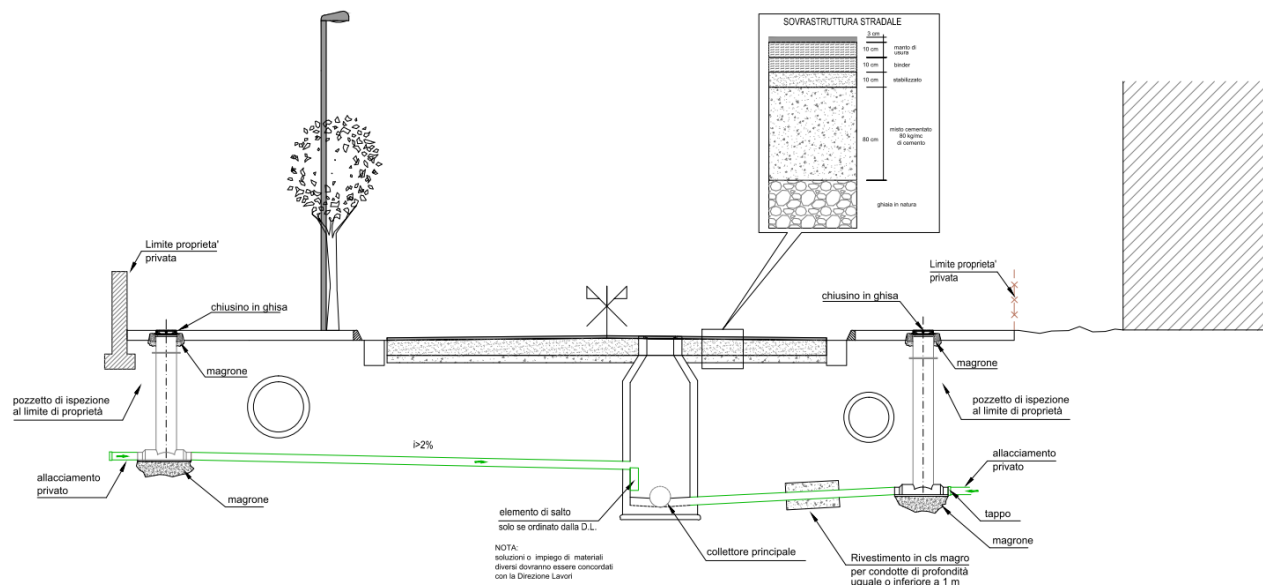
Sezione stradale tipo con fossi di guardia tombati
